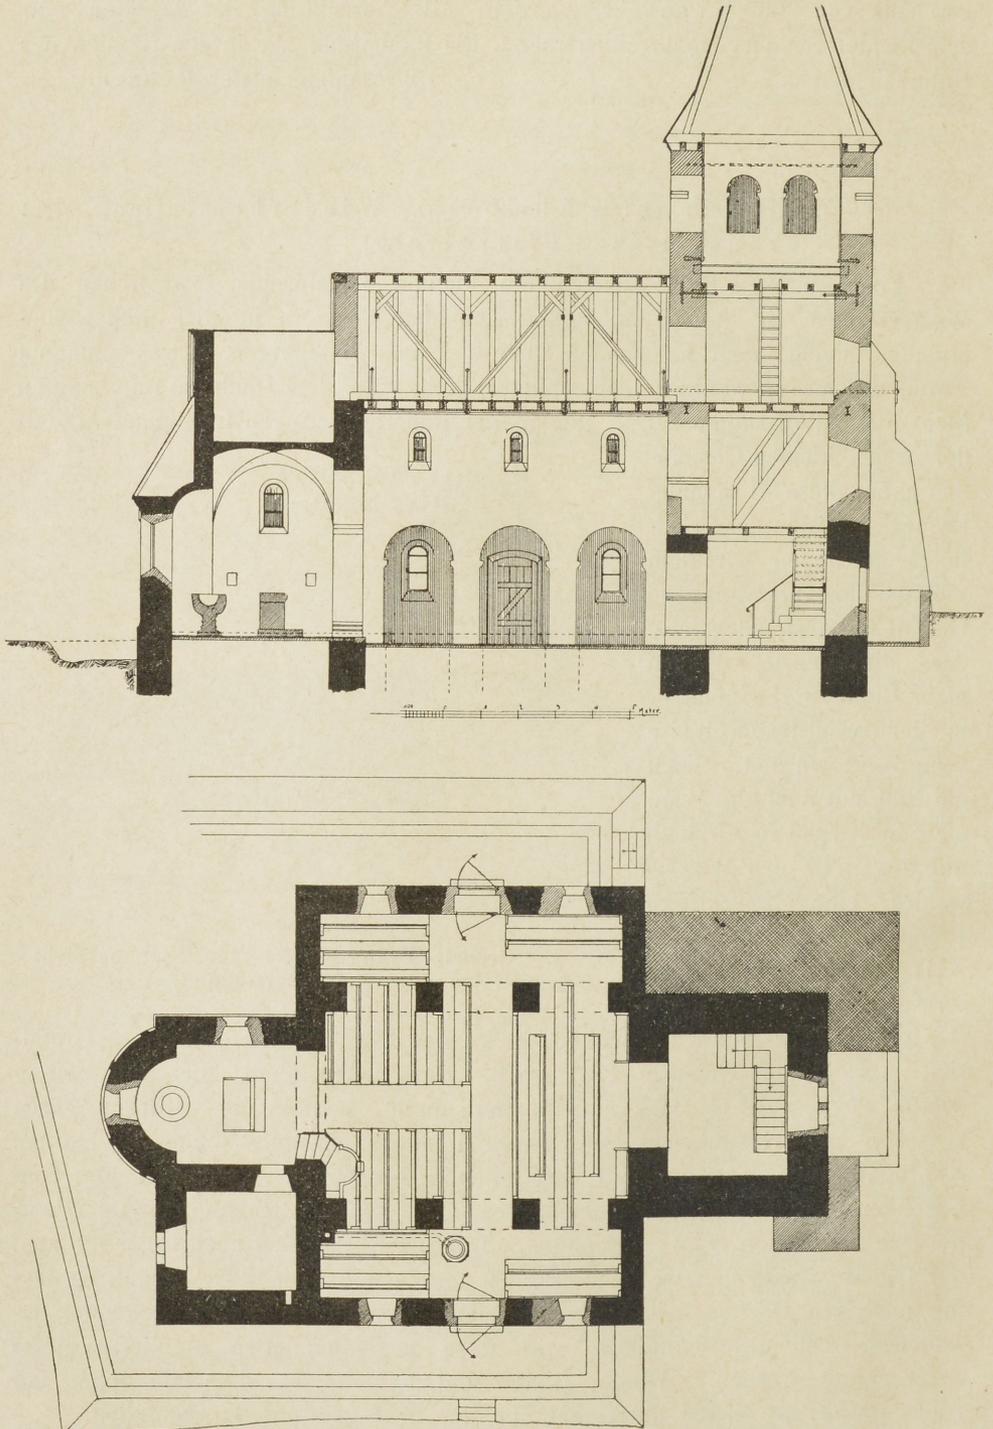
Kircheib, evang. Pfarrkirche. Längenschnitt und Grundriss nach der Wiederherstellung.
